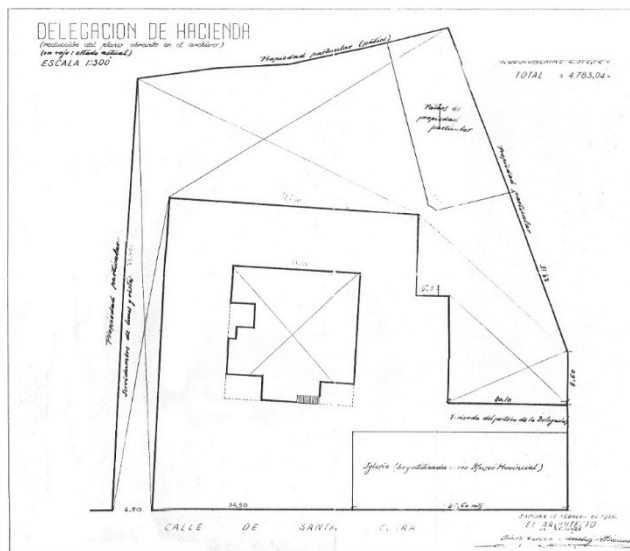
Plano de la sede de la Delegación de Hacienda en 1956 elaborado por el arquitecto de Hacienda, Antonio García Sánchez-Blanco (AMSV).
